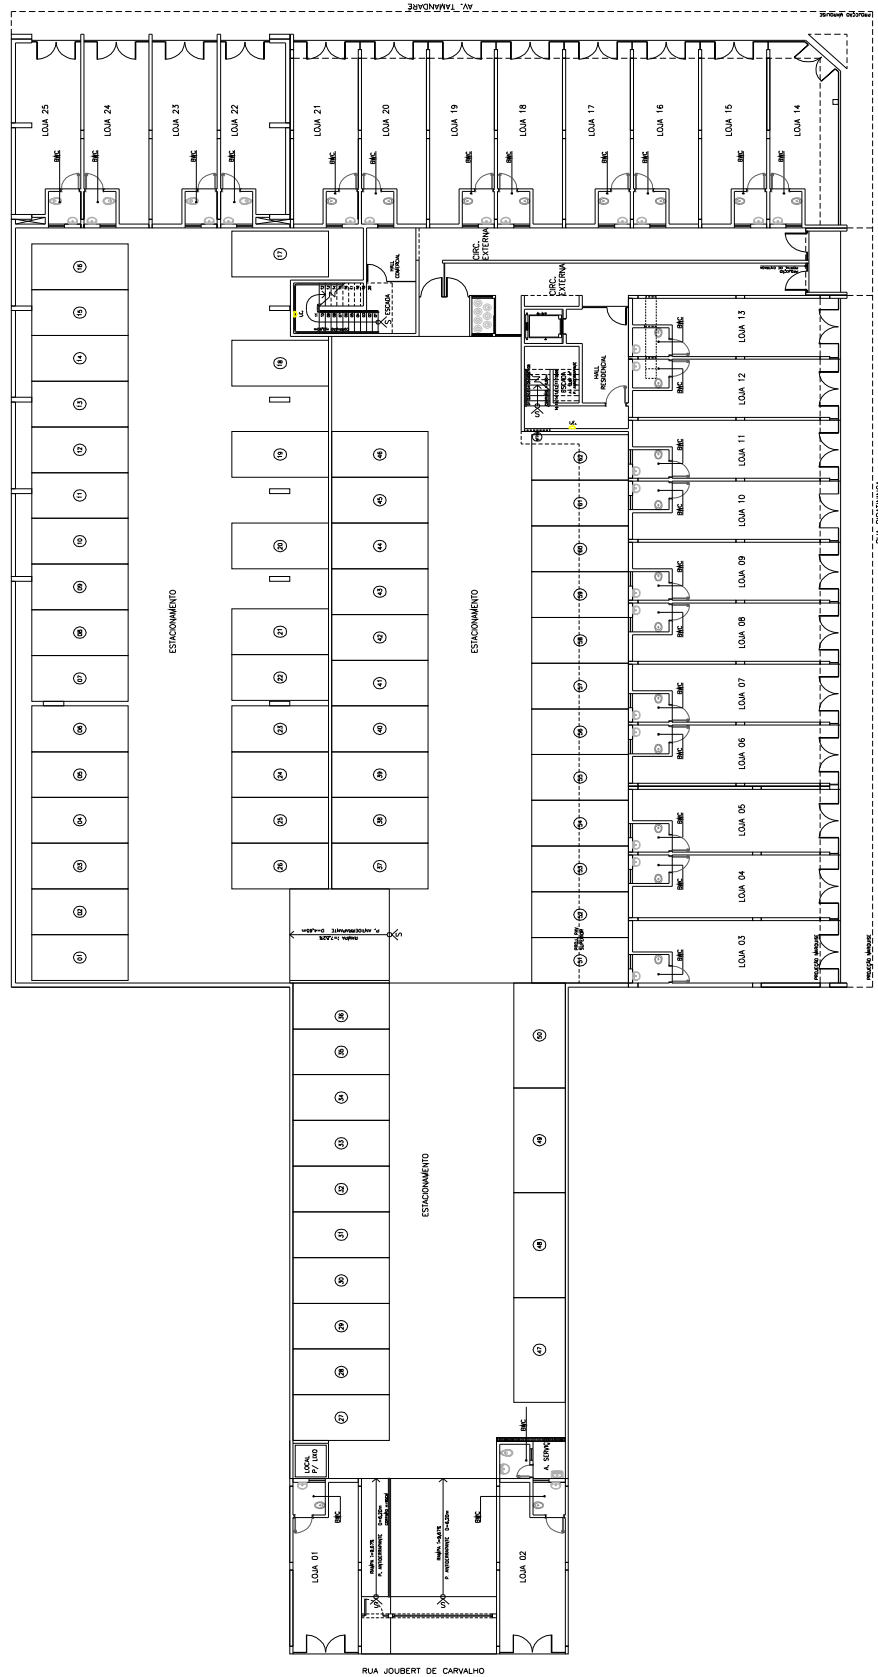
Planta baixa do pavimento térreo – Obra B
